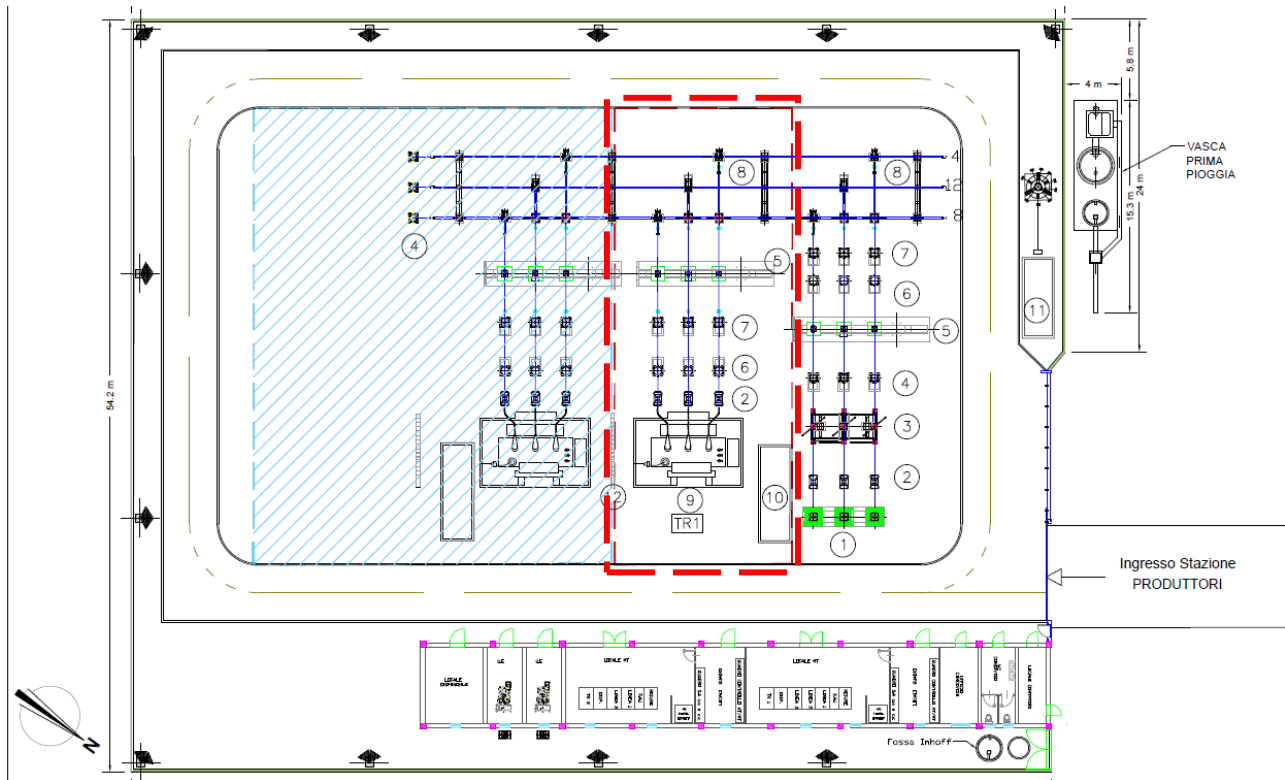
layout stazione elettrica - impianto Acea Solar e condominio
